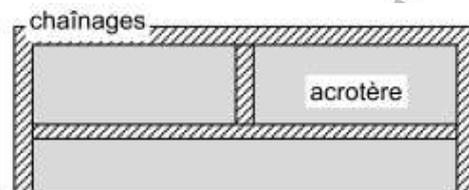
exemple d'encadrement des éléments en console vertical
